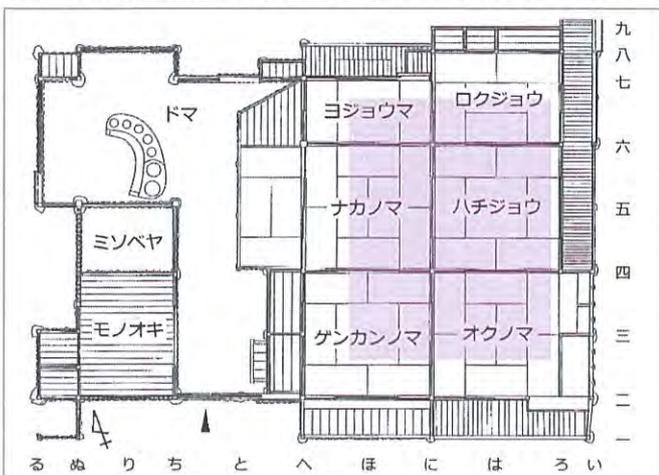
堀家住宅現状平面図 推定前身建物の広さ（桃色）
